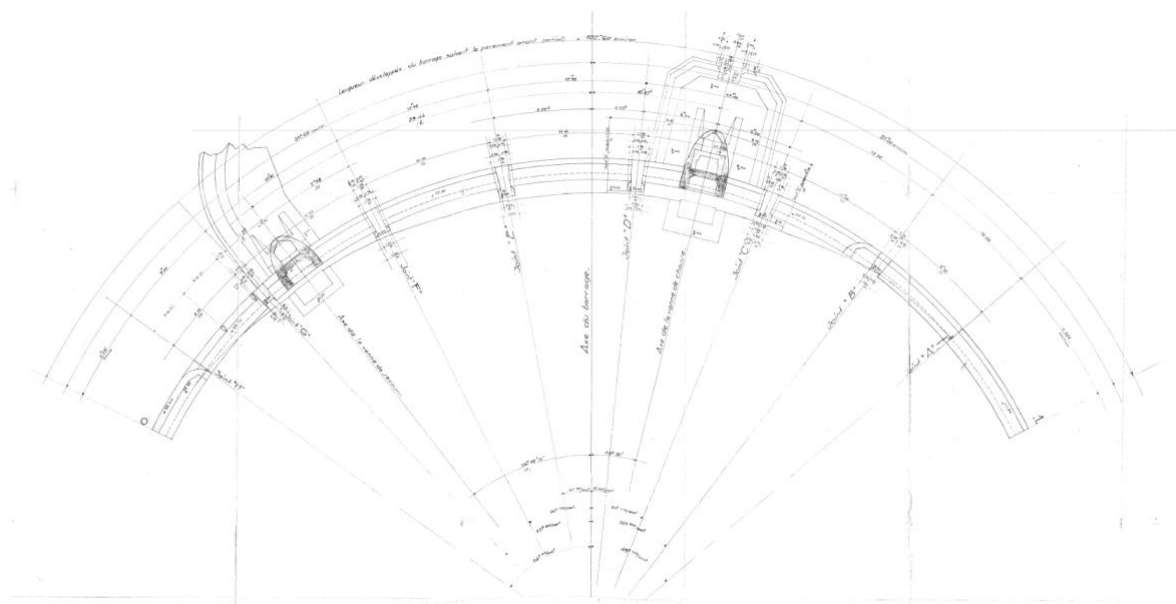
Vue en plan du barrage de Pont Rolland
